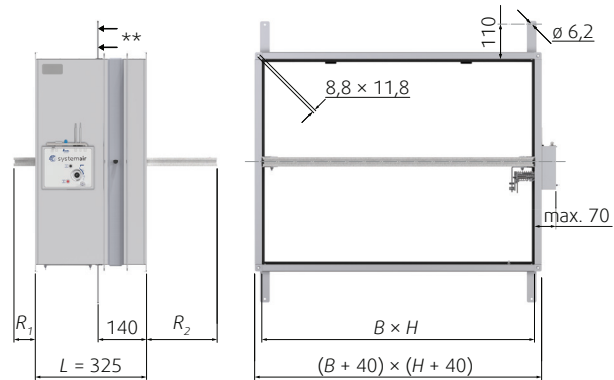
Dimensioner för manuellt rektangulärt brandspjäll PKIS3G (nominella dimensioner: 100 × 100 mm till 1200 × 800 mm) och PKIS3GA (nominella dimensioner 850 × 100 till 1200 × 300 mm)
